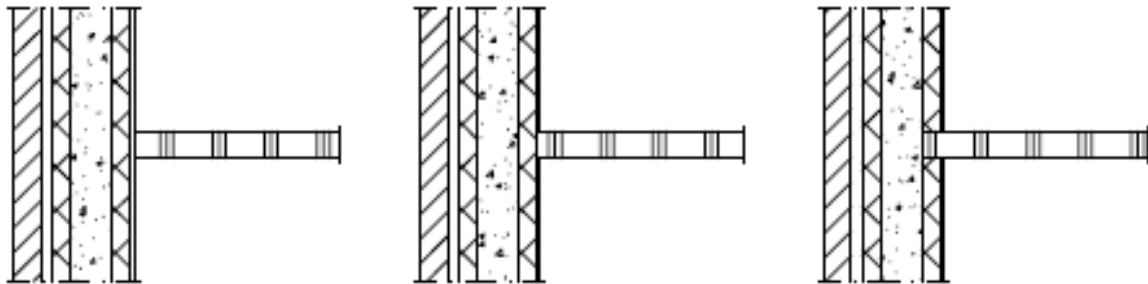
Detail 9 aansluiting kozijn op e-Block wand. Dezelfde tekening staat met meer informatie in bijlage 8.
